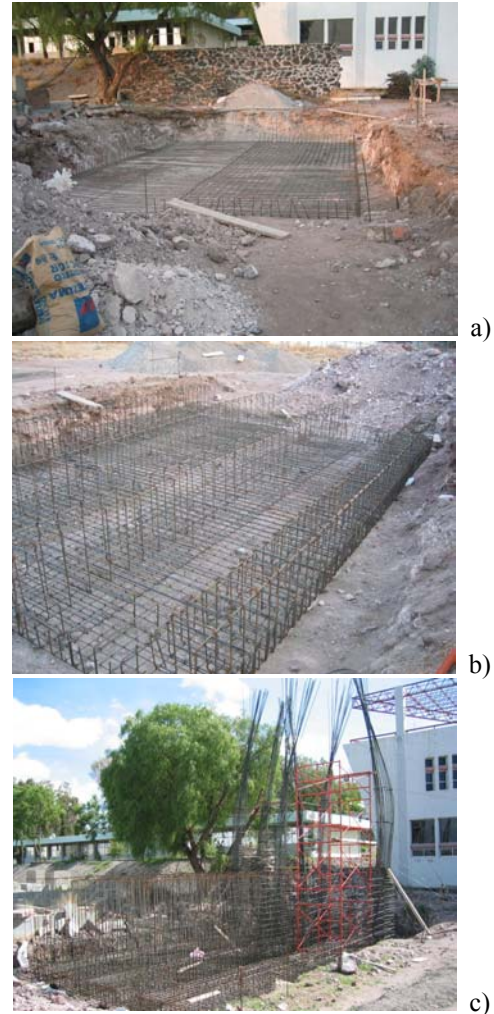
a) Limpieza, trazo y nivelación del terreno, b) armado de la base de la losa de cimentación, c) muro de reacción en general
